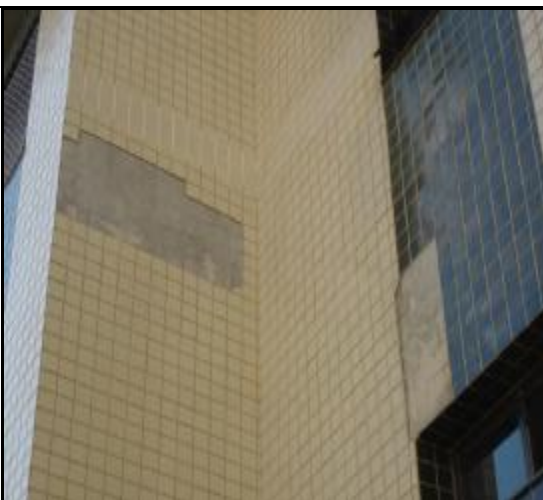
VISTA GERAL DA FACHADA LATERAL ESQUERDA, MOSTRANDO DESPLACAMENTO JUNTO AO ENCONTRO DE PAREDE E PEÇA ESTRUTURAL DO PRÉDIO.
